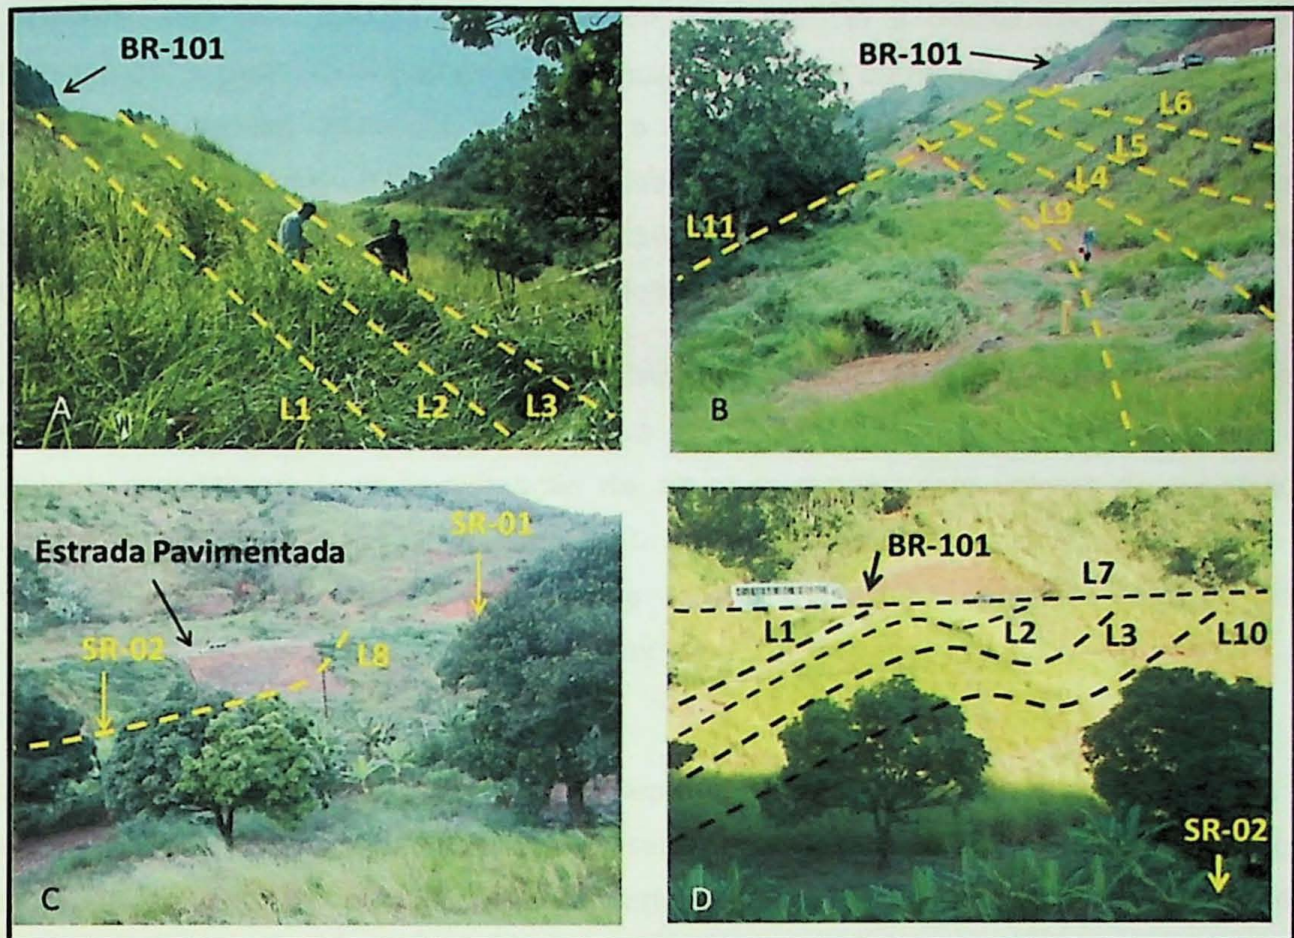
(A) Vista Norte com destaque para as seções geofísicas; (B) Vista Sul com destaque para as seções geofísicas; (C) Vista Leste com destaque para as seções geofísicas e as Sondagens; (D) Vista Oeste com destaque para as seções geofísicas e a sondagem SR-02.
